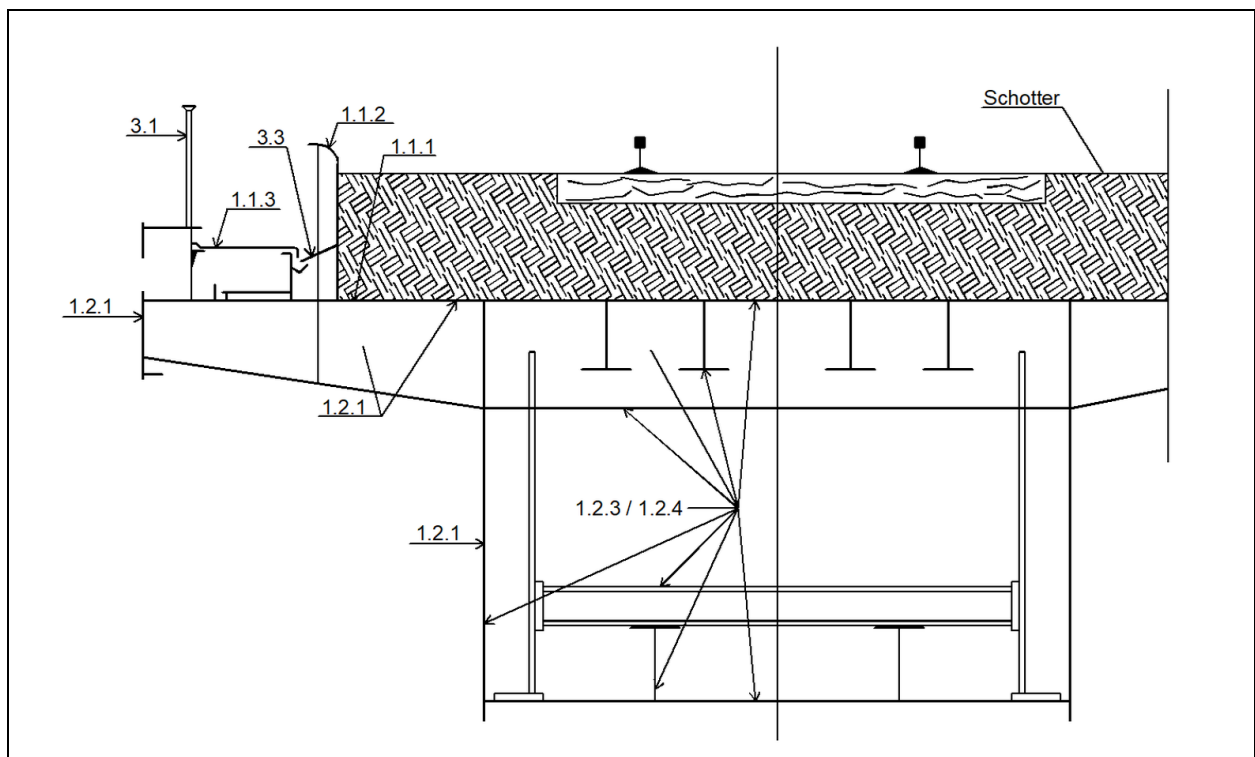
Querschnitt eines Hohlkastenüberbaus für Eisenbahnbrücke mit Schotterbett
